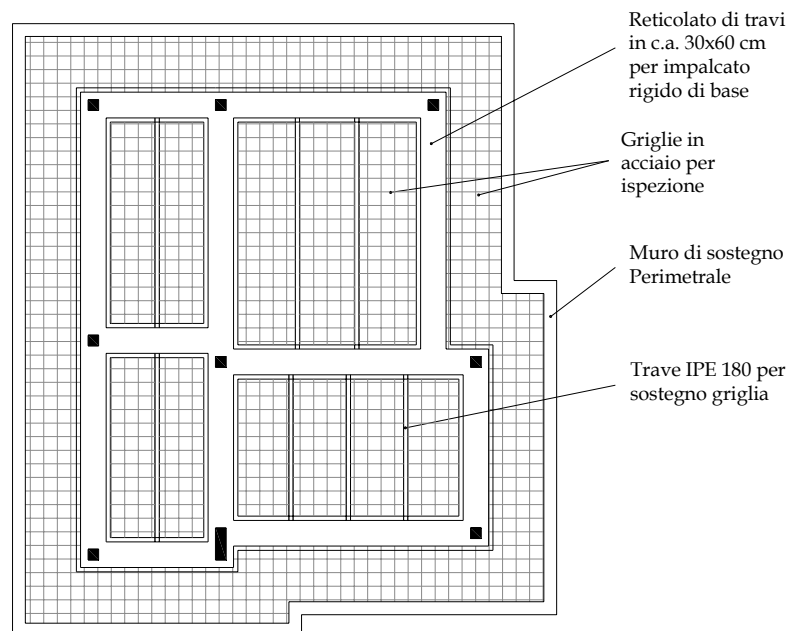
Pianta dell'impalcato sovrastante il livello di isolamento: disposizione dei profili e delle griglie in acciaio per l'ispezione e la manutenzione dei dispositivi.
